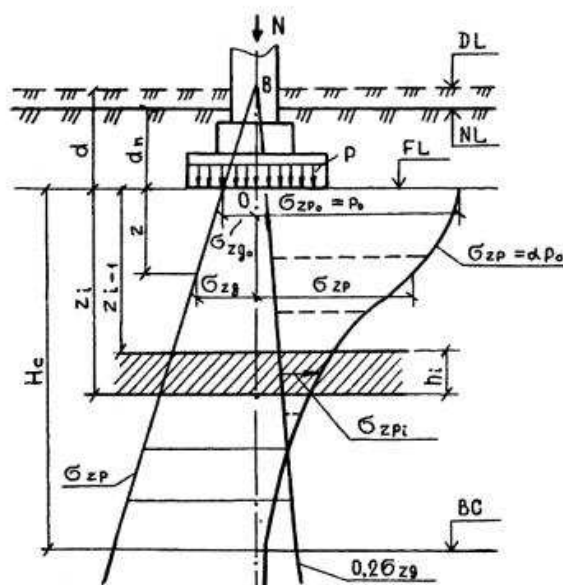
Схема к определению осадки фундамента методом послойного суммирования
